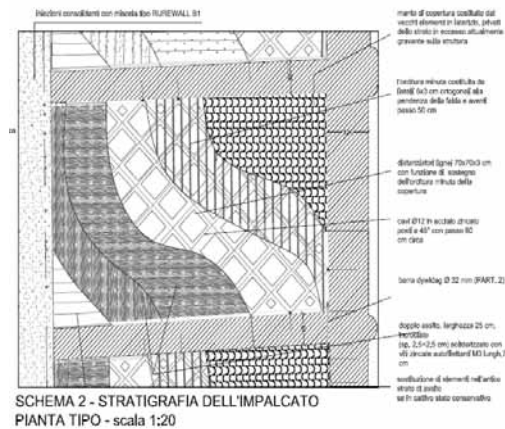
Immagini e dettaglio costruttivo planimetrico del doppio assito ligneo armato in copertura.
